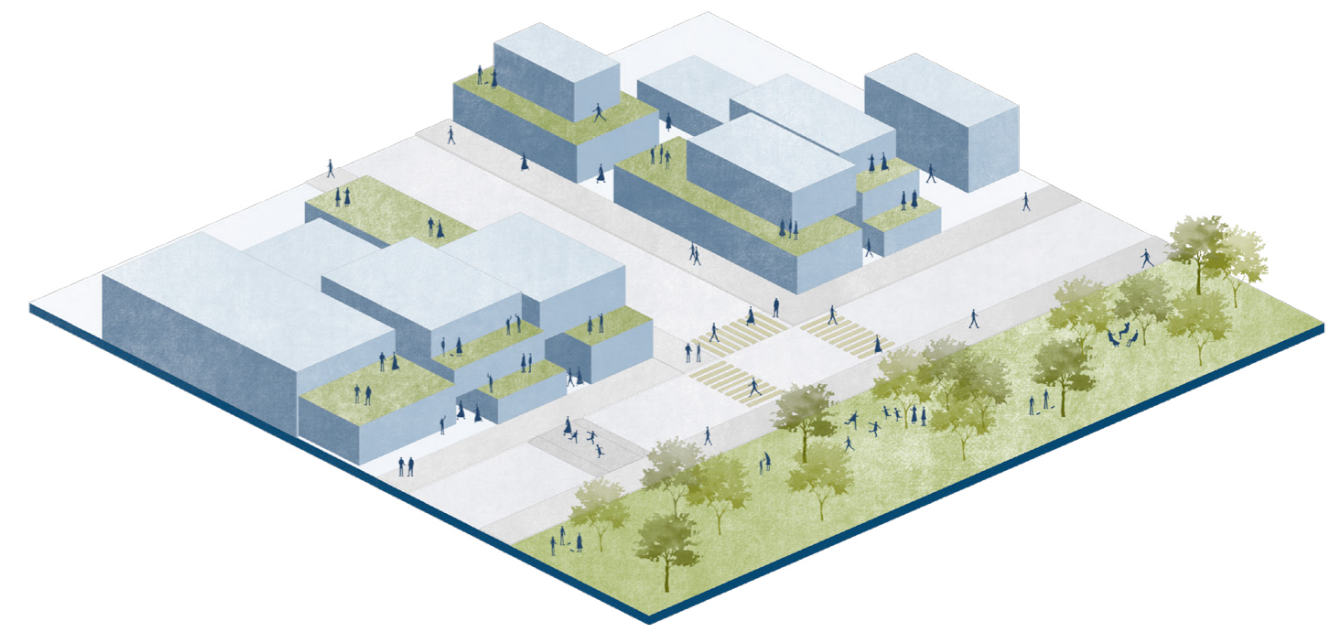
Conectividad. Fuente: Elaboración propia, 2022
